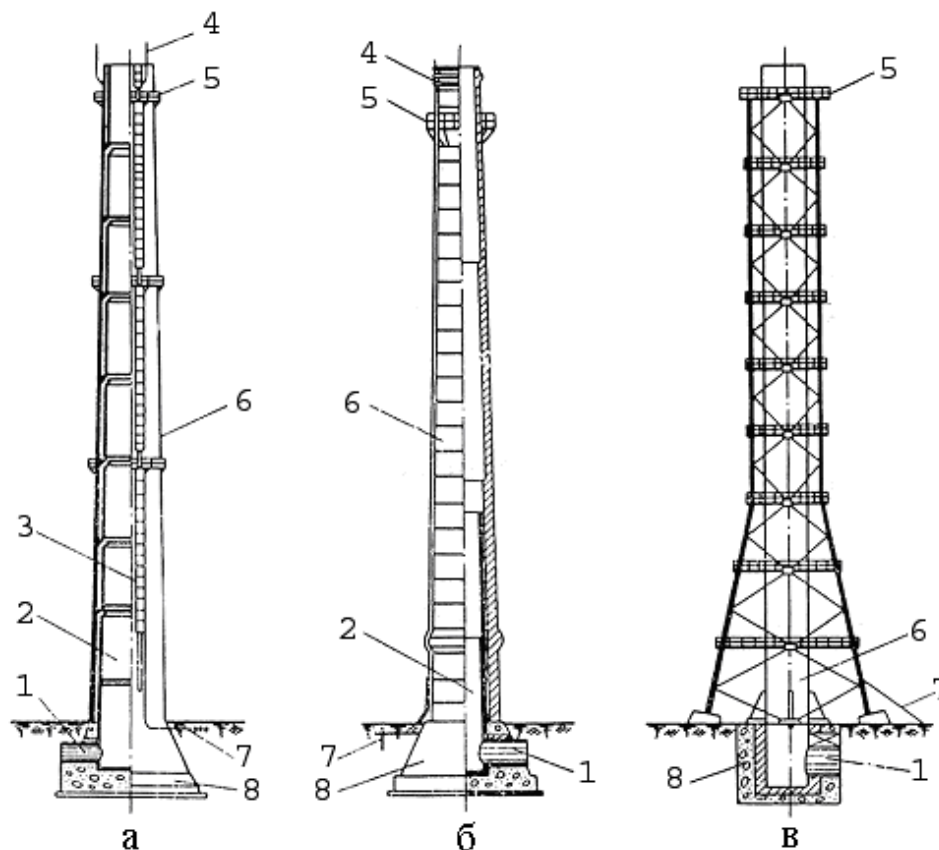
Дымовые трубы: а – железобетонная; б – кирпичная; в – металлическая; 1 – фундамент; 2 – огнеупорная футеровка; 3 – ствол трубы; 4 – площадка; 5 – газоход; 6 – молниеотвод; 7 – заземление; 8 – лестница
